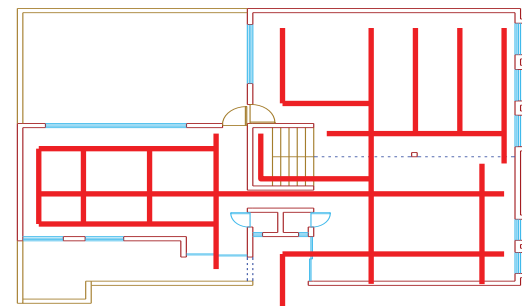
Planta baja, muestra circulaciones en forma lineal y un sistema de escalera que conduce al segundo piso.
